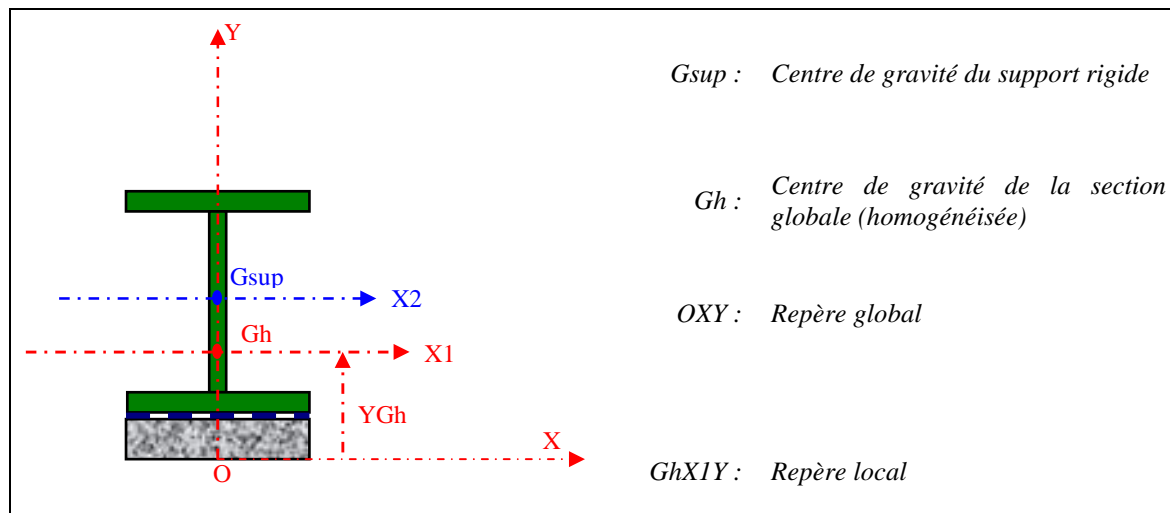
Modélisation du test de fissurabilité
